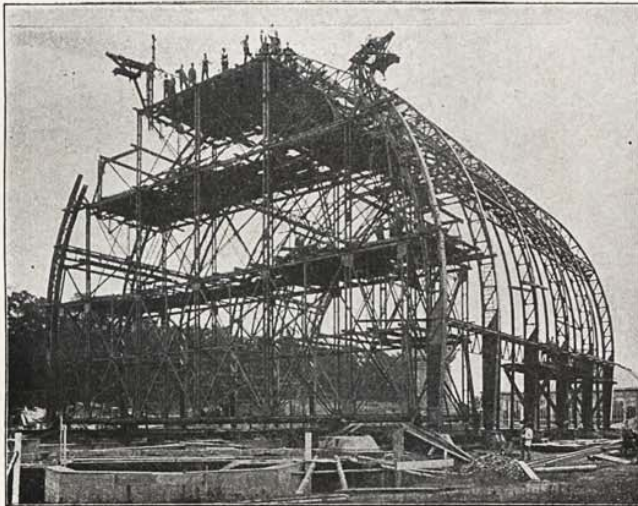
Großes Tropenhaus. Aufstellung des Eisengerüsts.
